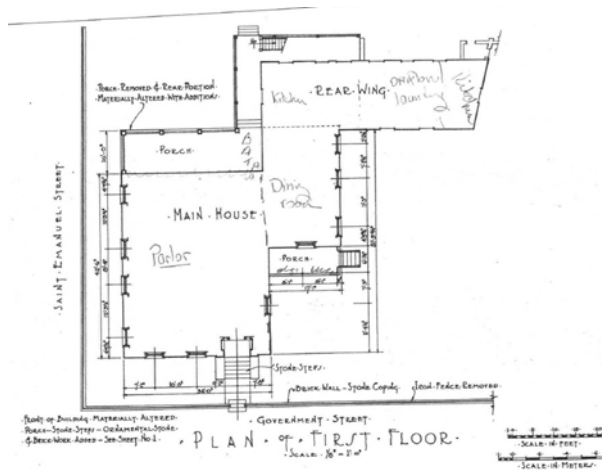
Fred W. Clarke: Madame Le Vert House, in: U.S. Department of the Interior Office of National Parks, Buildings, and Reservations, Branch of Plans and Design, Survey No. ALA-29, n.d.
